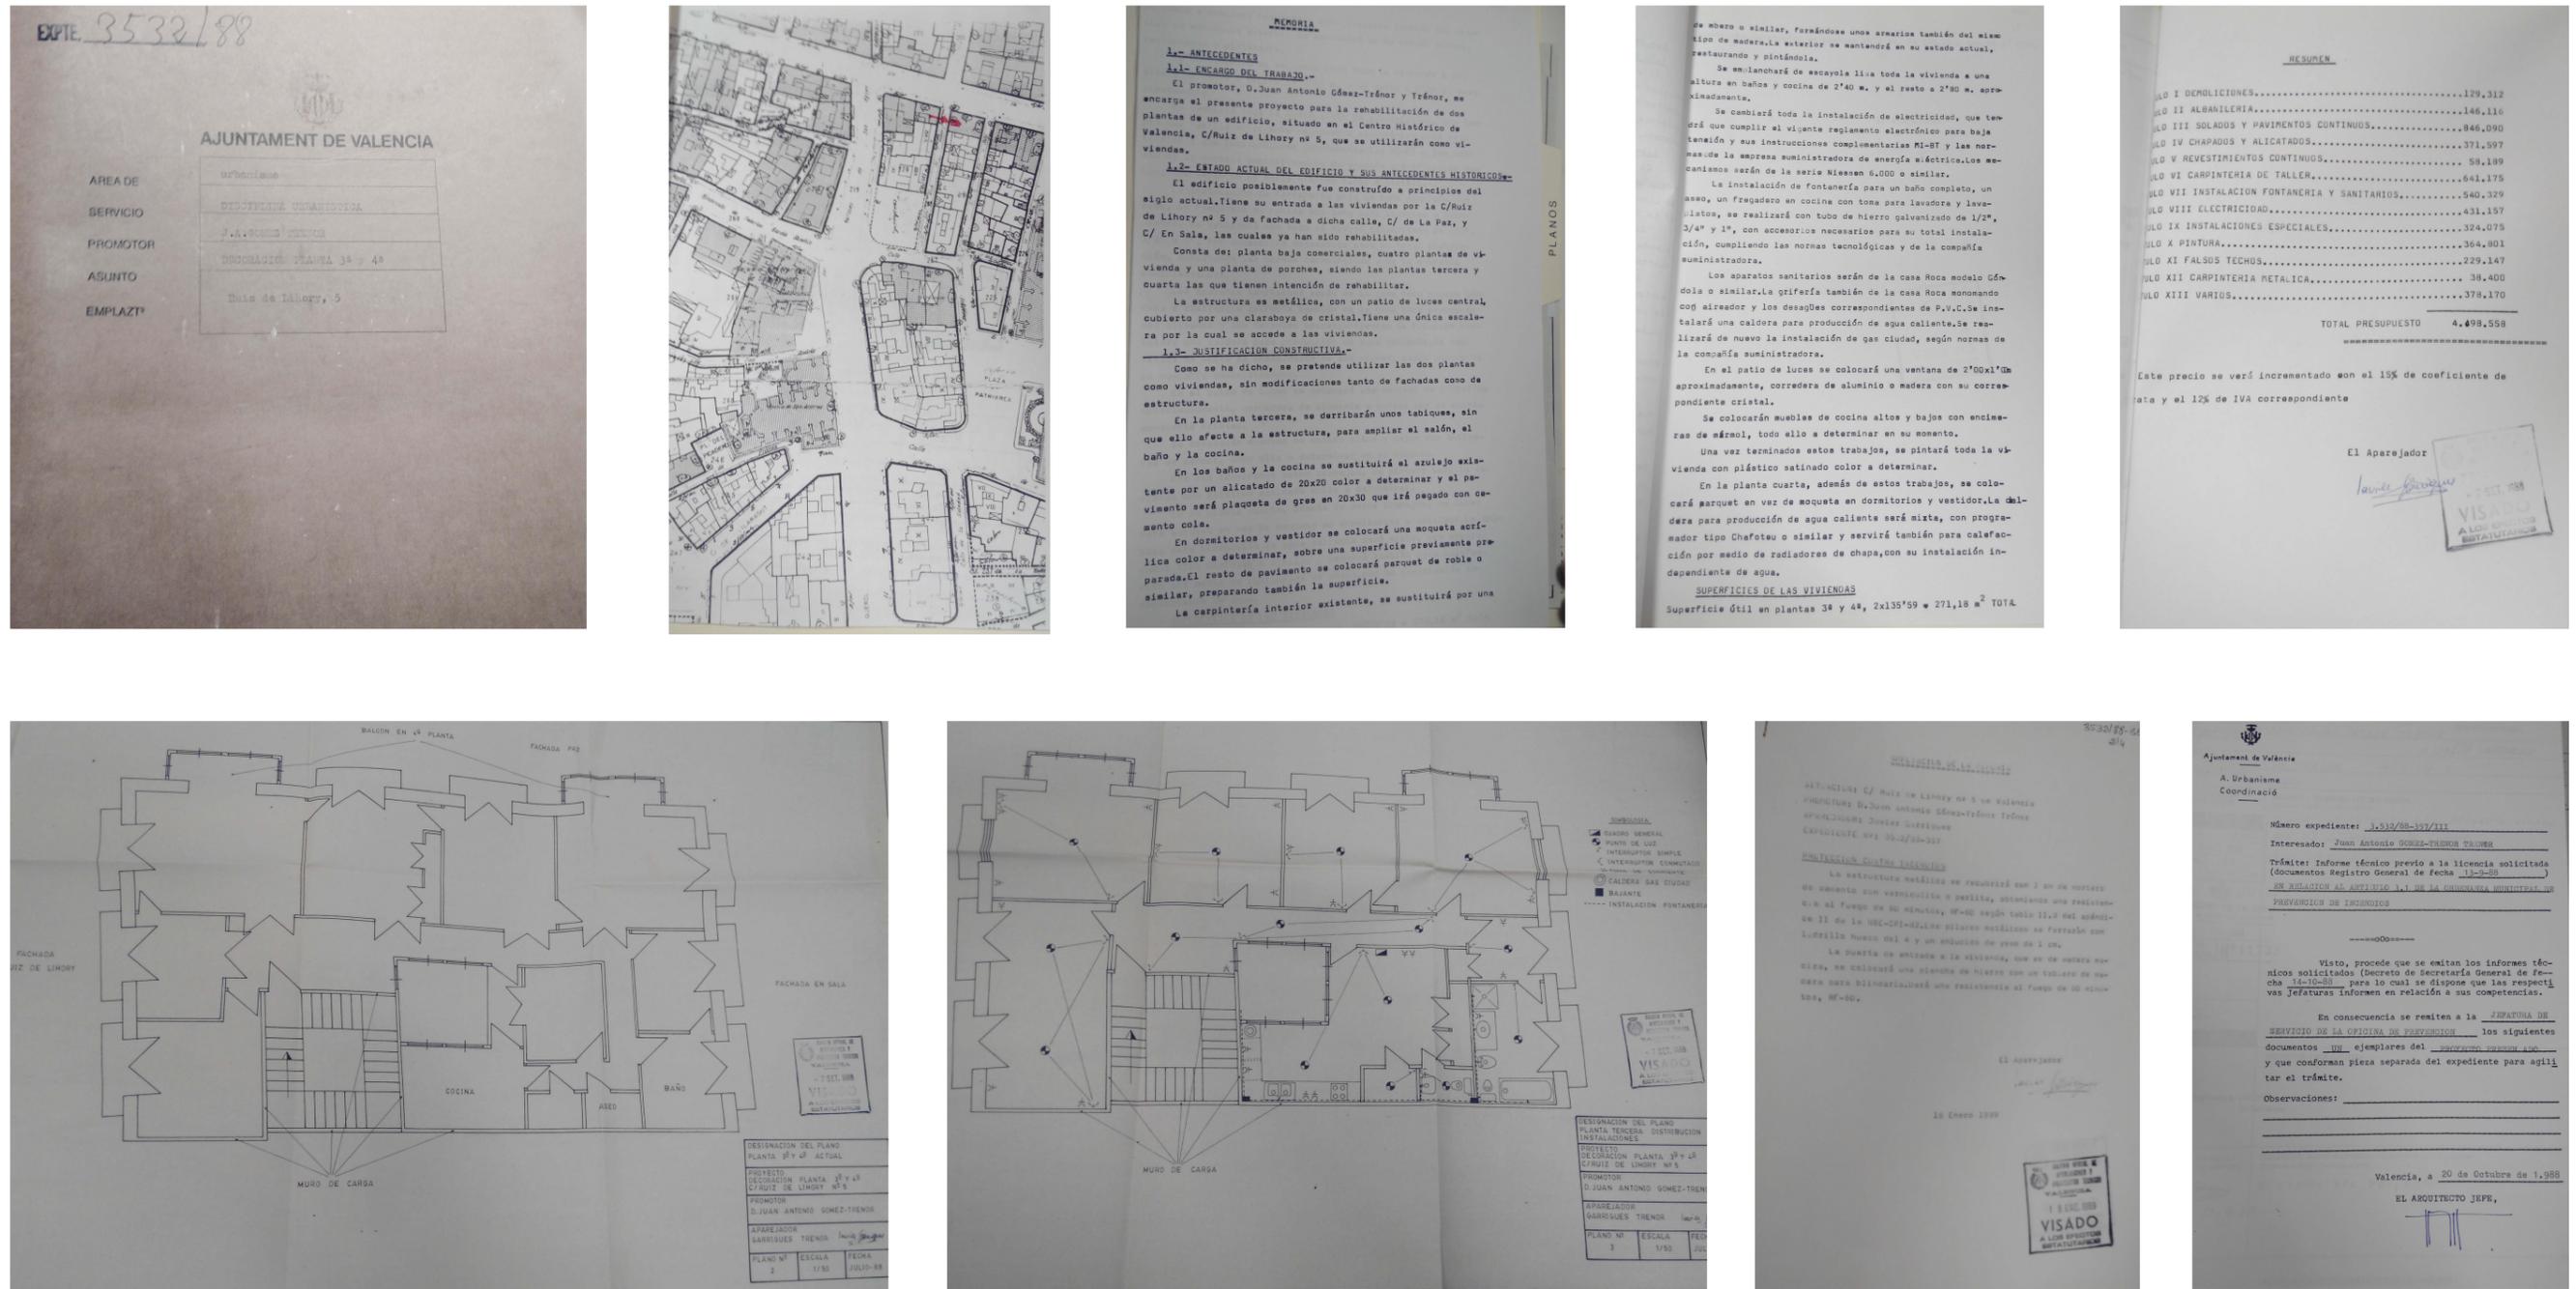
Extractos del proyecto de reforma de la planta 3ª y 4ª de la Calle de la Paz nº 18 realizado por Javier Garrigues Trenor.1988.Registro municipal intermedio Ayuntamiento de Valencia.
